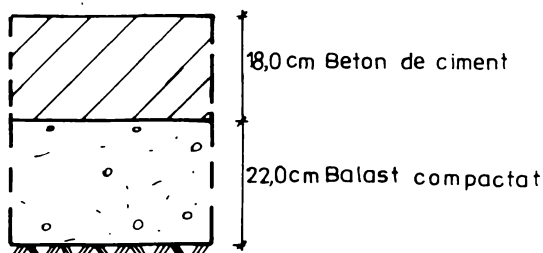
Structură rutieră cu beton de ciment folosită la lărgiri.
